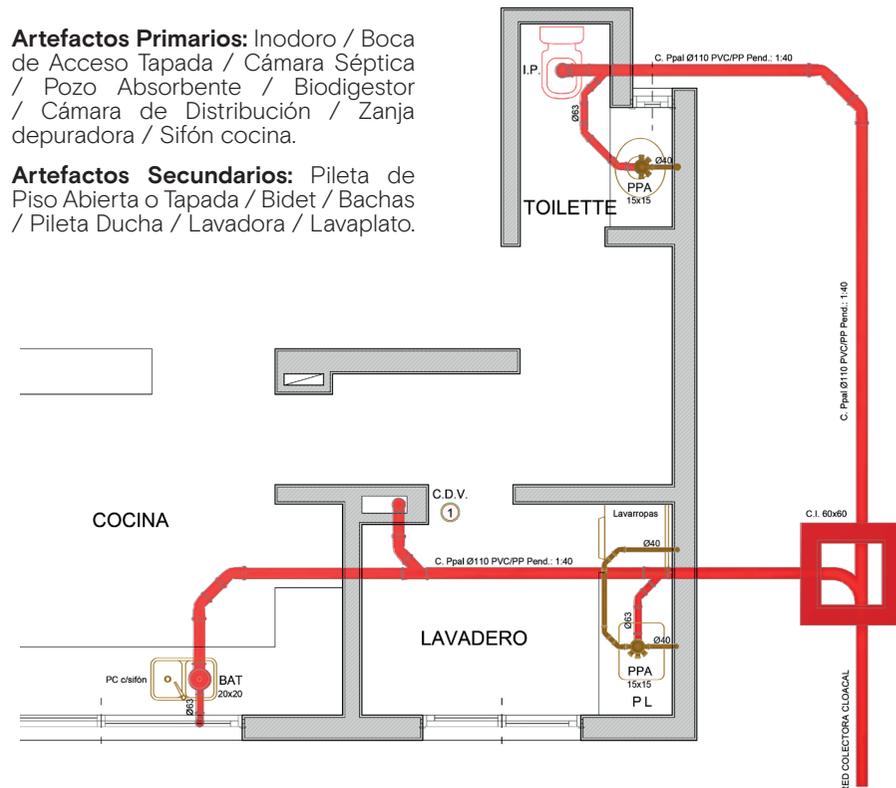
Instalación de Desagüe Cloacal en Planta Baja.
